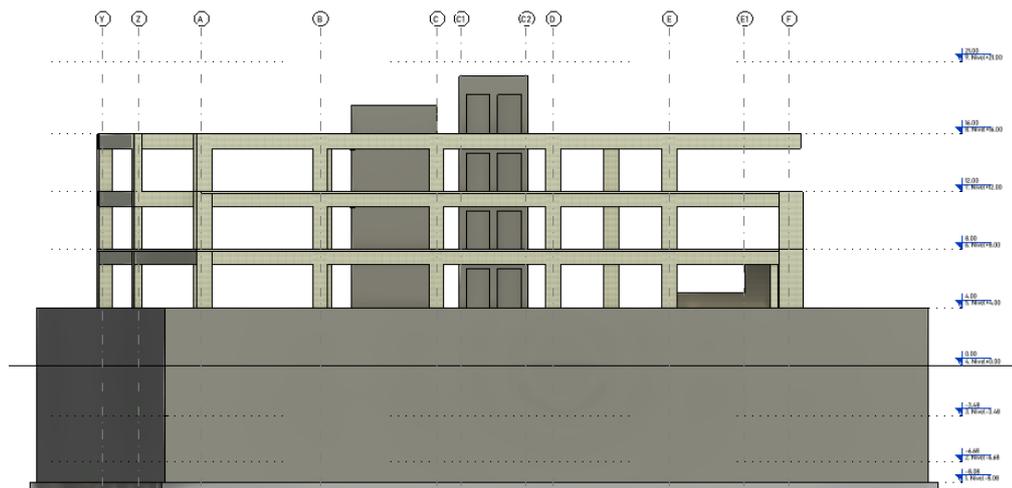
Fachada Sur Modelo Estructural 3D. (Elaboración Propia)
